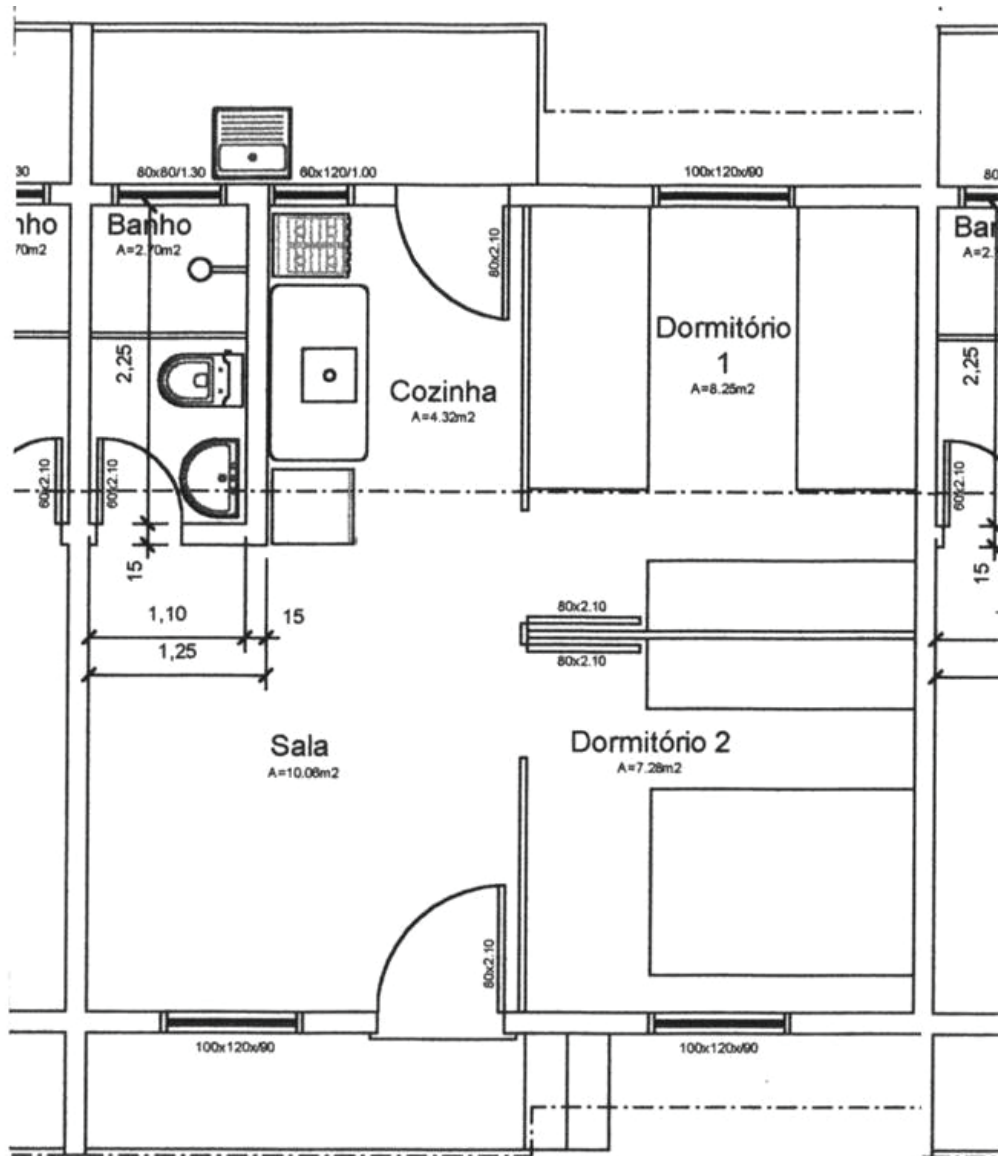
Planta baixa da habitação 1, 2, 3 e 5
